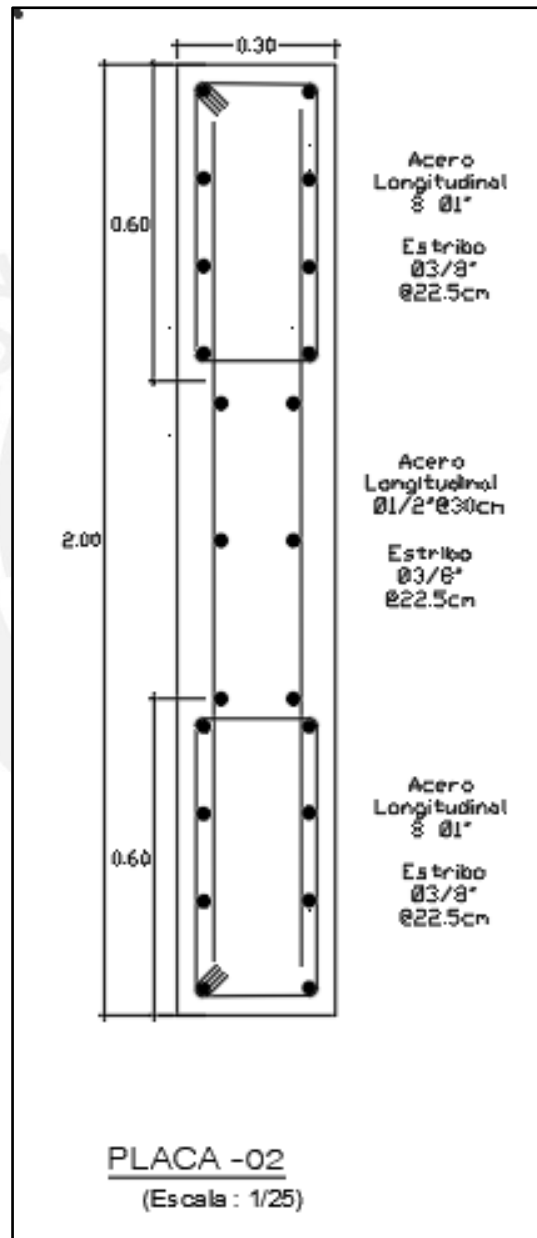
Detalle de hacer para la placa 02 sección transversal (Fuente propia)
